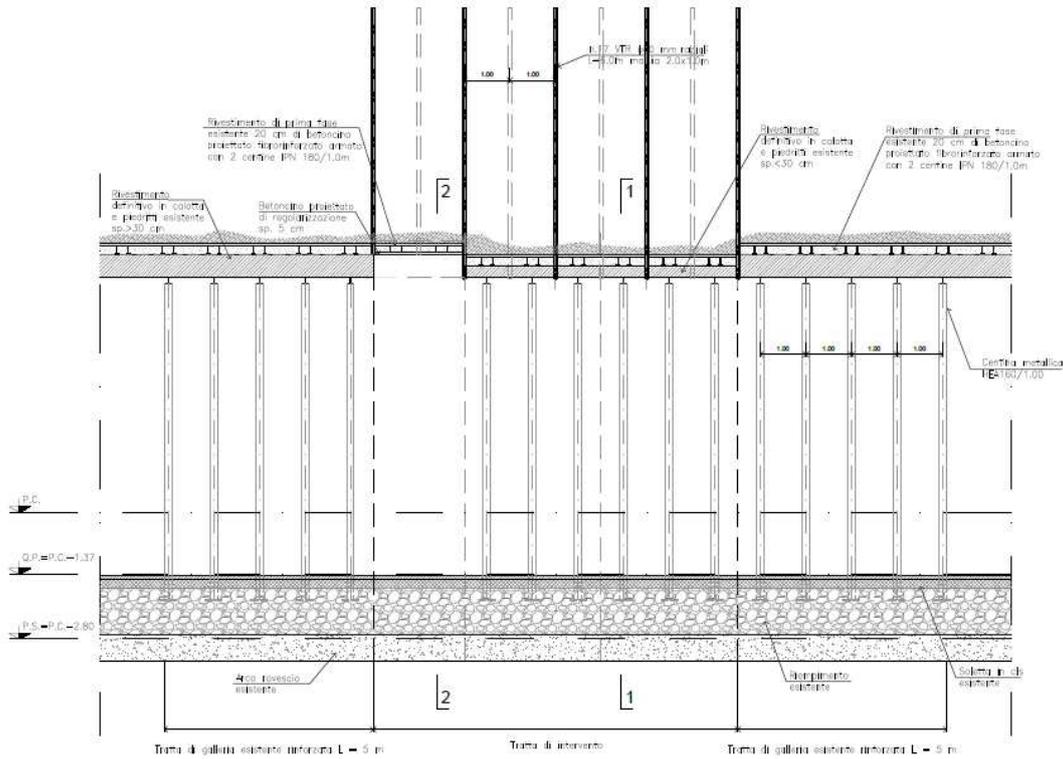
Galleria Guinza – Intervento Tipo A – Sezione corrente – Scavo – Profilo
